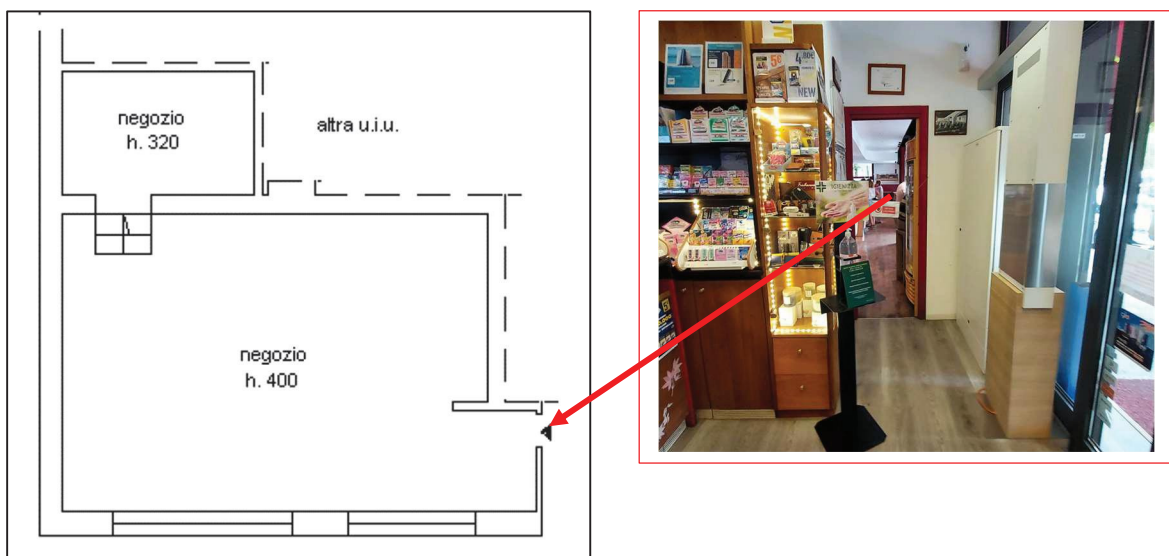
planimetria catastale con indicazione della porta di collegamento con l'unità attigua
